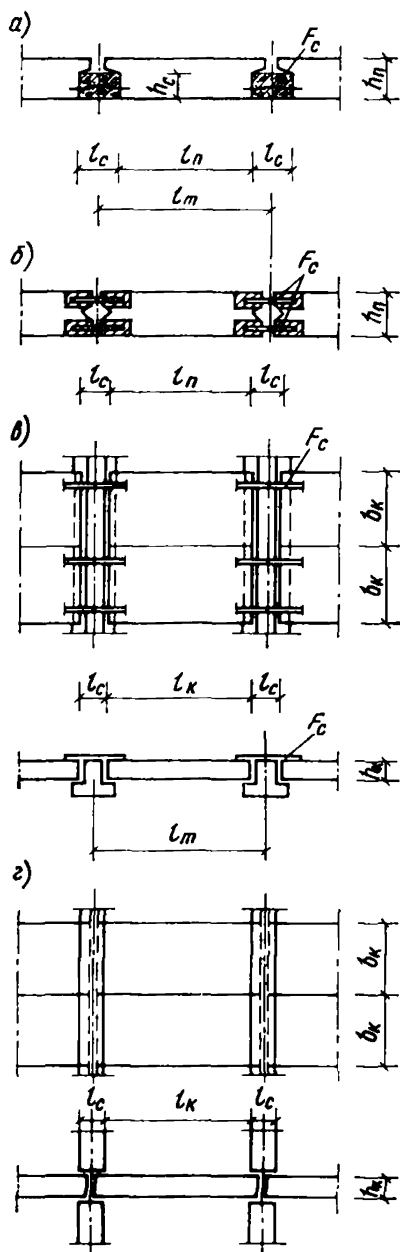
Типы соединений панельных стен и сборных перекрытий
